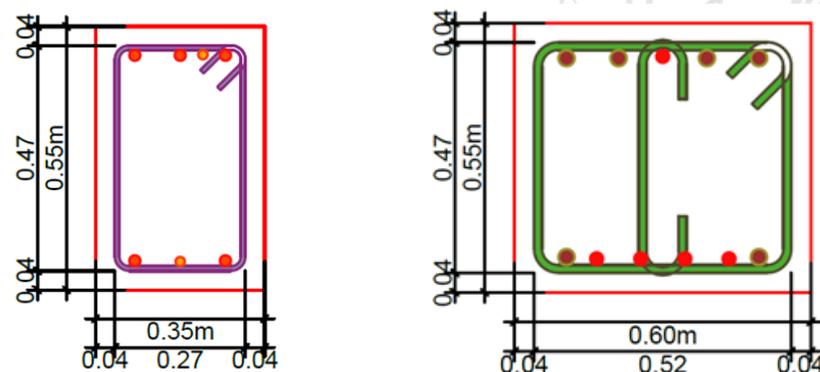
Detalle vigas principales V2 y V3' respectivamente
